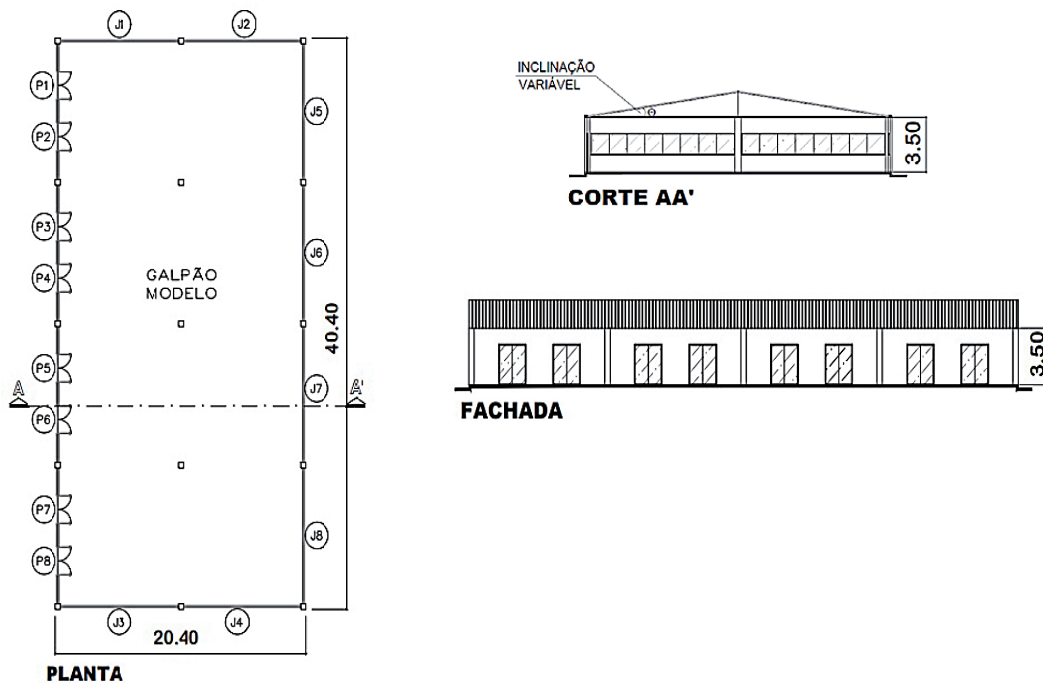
Planta do galpão modelo – Corte AA' e Fachada.
